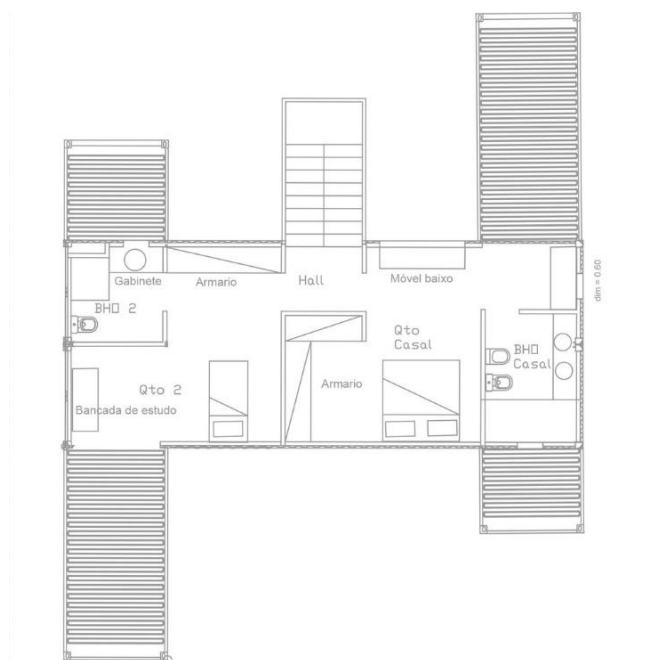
Planta baixa do 1º pavimento da Casa Contêiner
